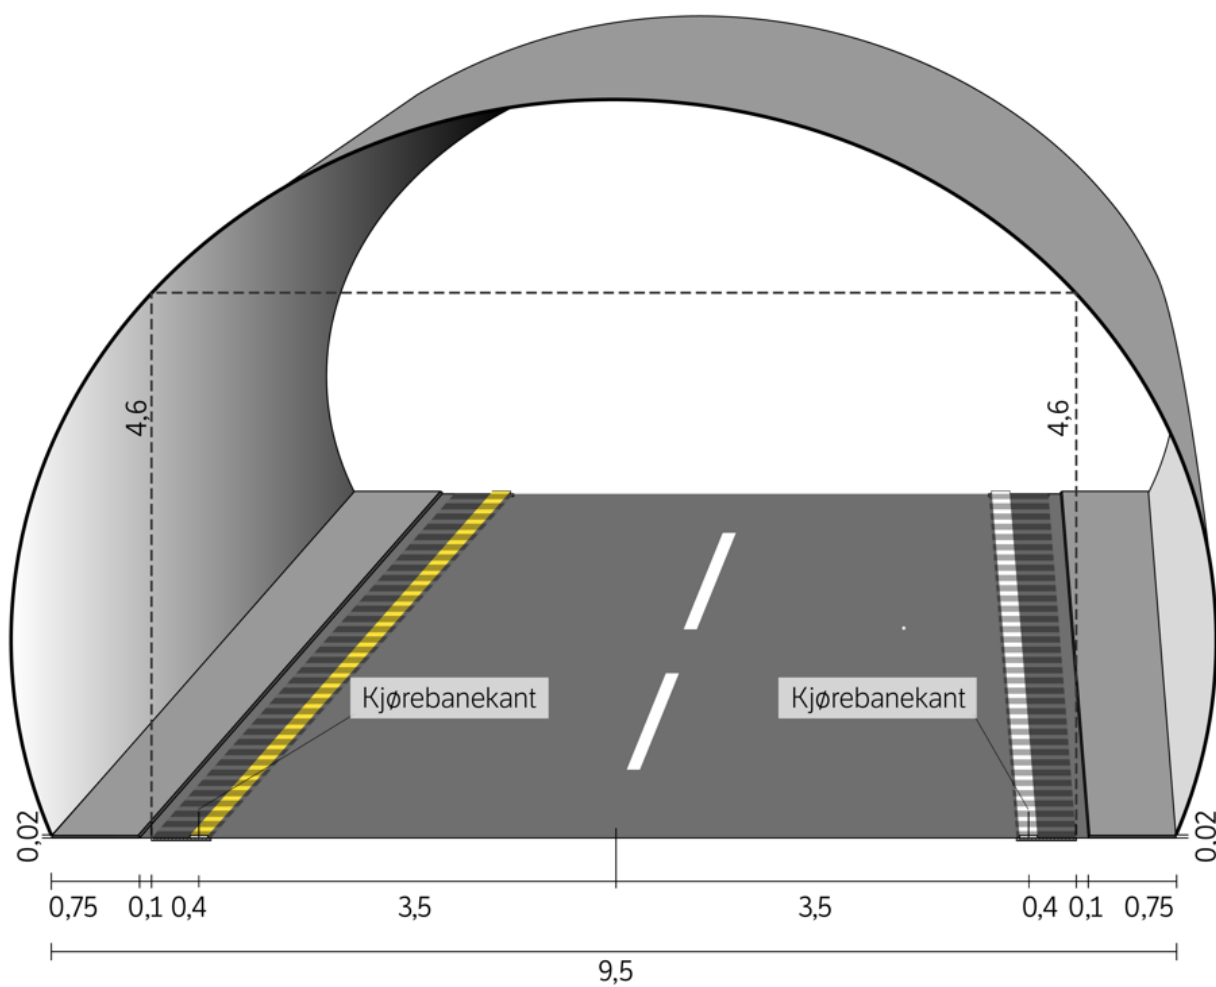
Tunnelprofil T9,5. Bruks ev. for toløpstunneler (mål i m).
